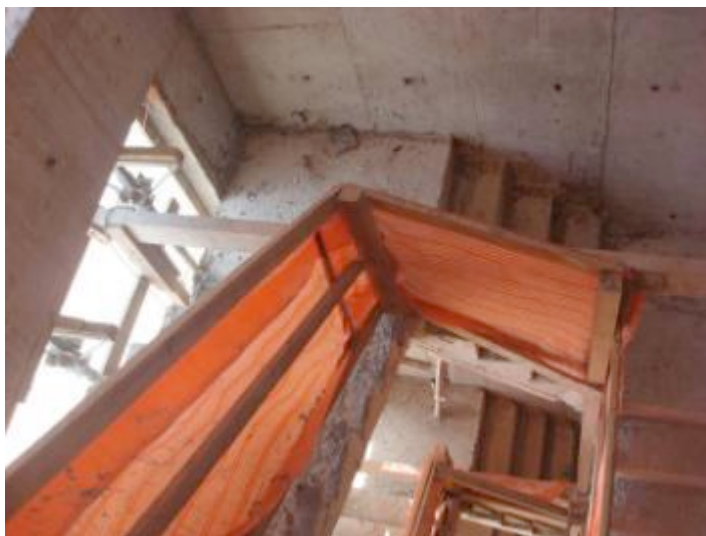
Estrutura para suporte da tela de proteção da fachada
